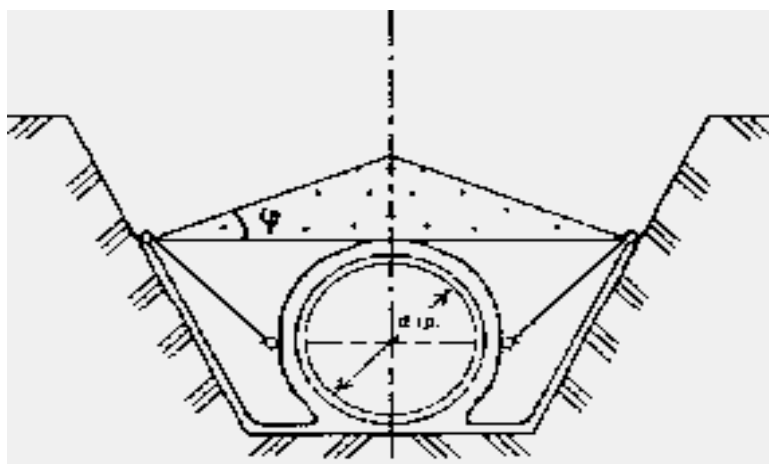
Балластировка нефтепроводов минеральным грунтом засыпки с использованием ПКБУ.
